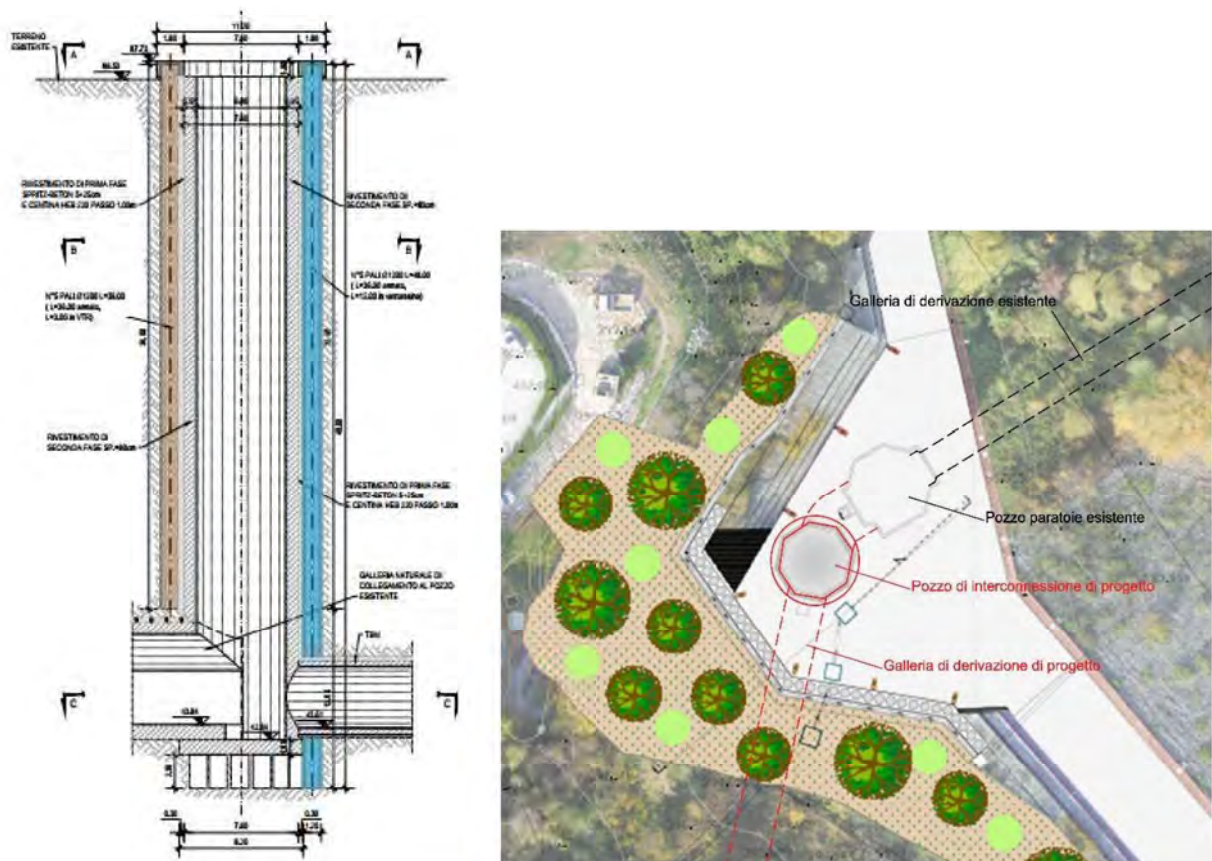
Layout opere di collegamento ai manufatti di presa preesistenti
